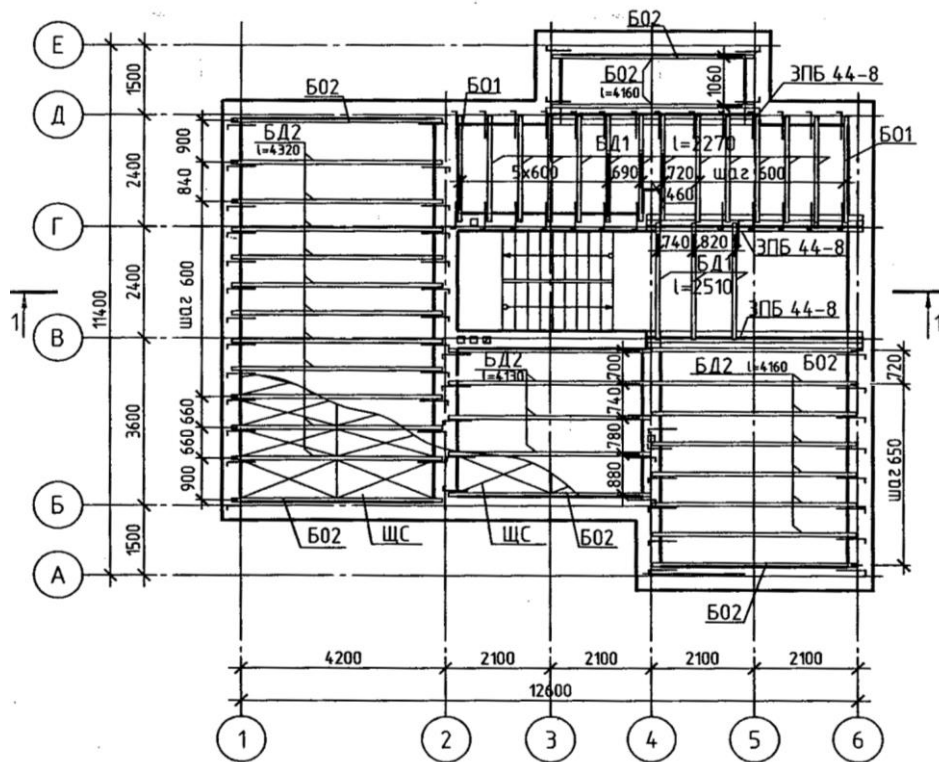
Пример выполнения плана перекрытия по деревянным балкам
